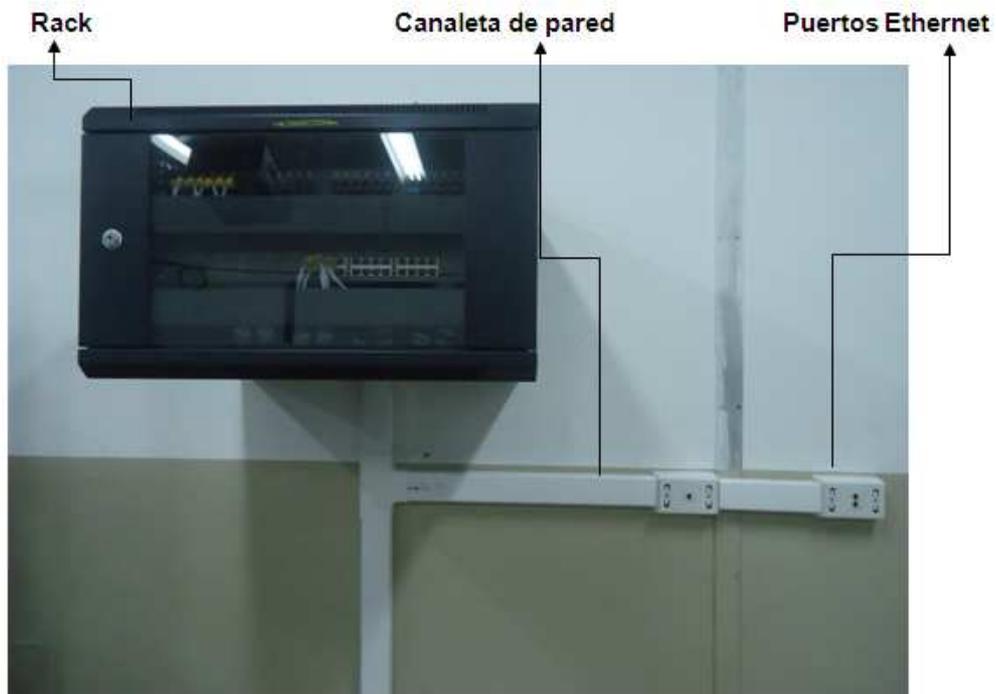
Vista frontal del rack, junto con las canaletas de pared y puntos de red
